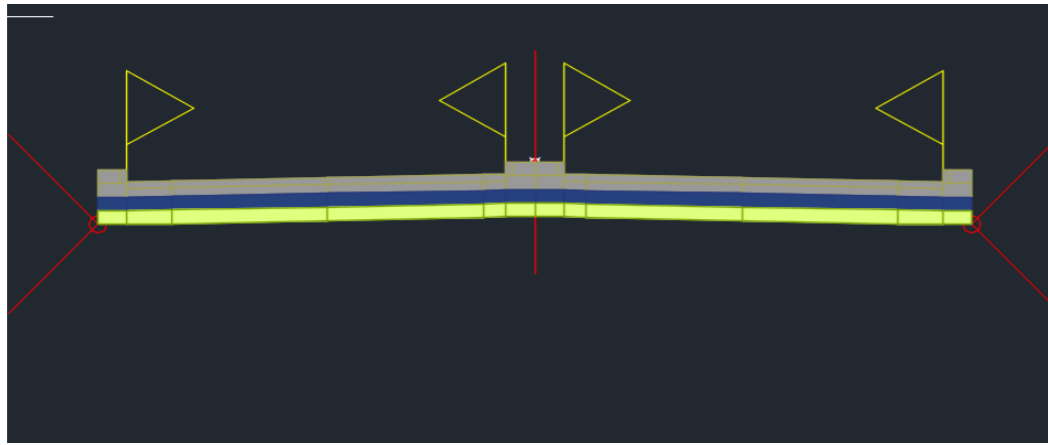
Sección transversal en Civil 3D. FUENTE: elaboración propia
